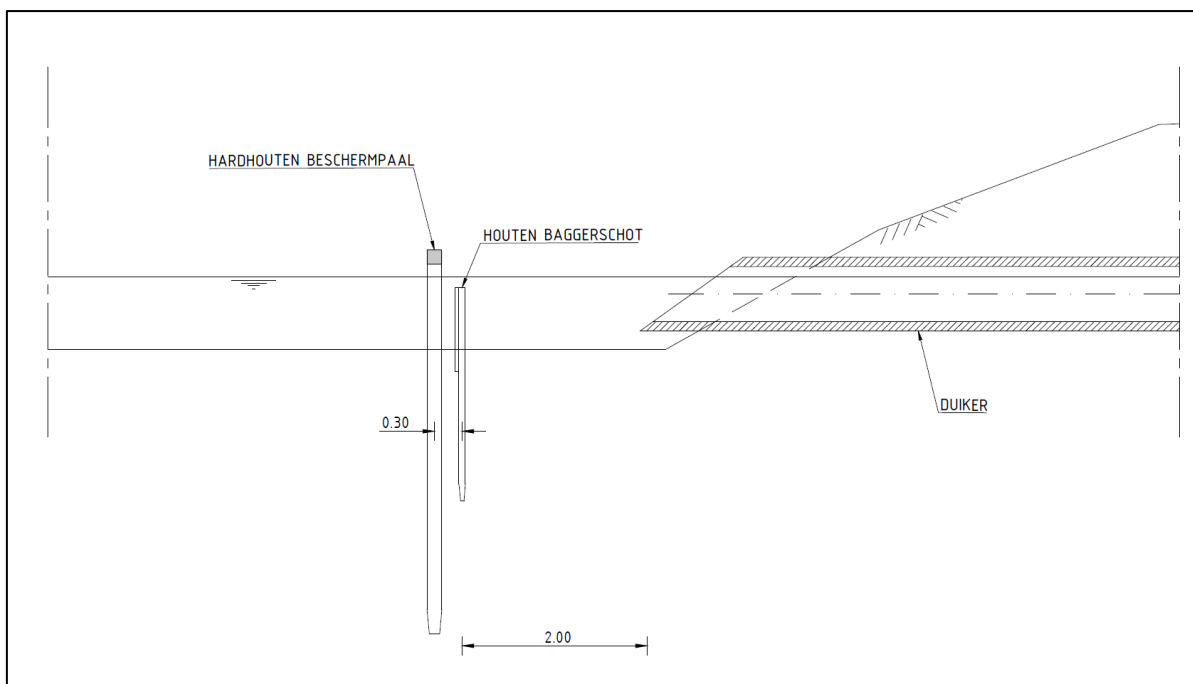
Detail beschoeiing, dwarsdoorsnede
